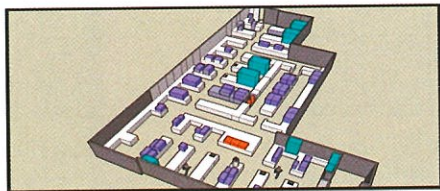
Plano de Piso del Laboratorio 1 rediseñado (Vista 3)
